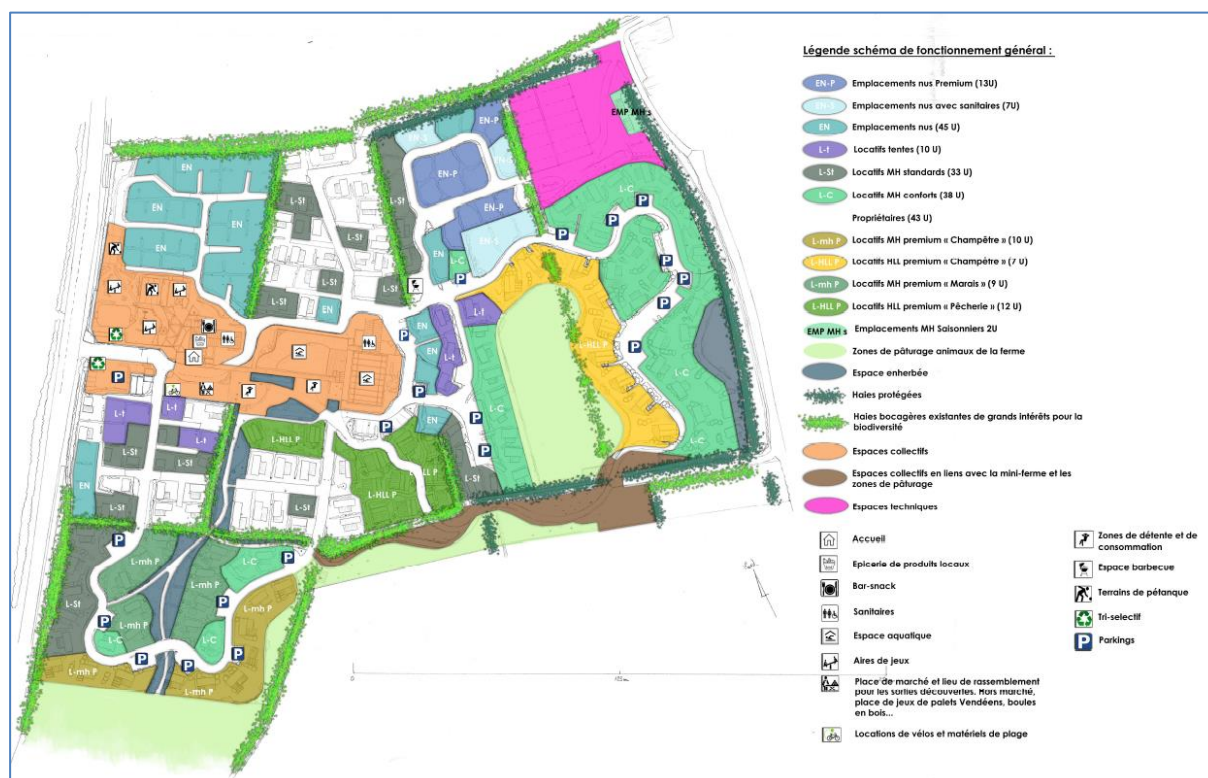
Plan de masse du projet [JDAH, Juillet 2024 – modifié en Novembre 2024]
